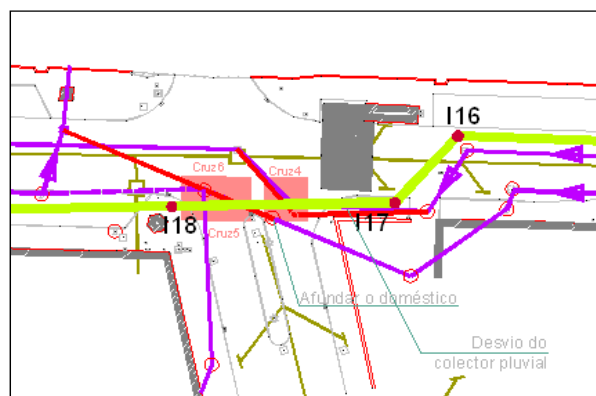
Esquema das alterações propostas e dos cruzamentos existentes na zona do poço de ventilação do Metro de Lisboa
